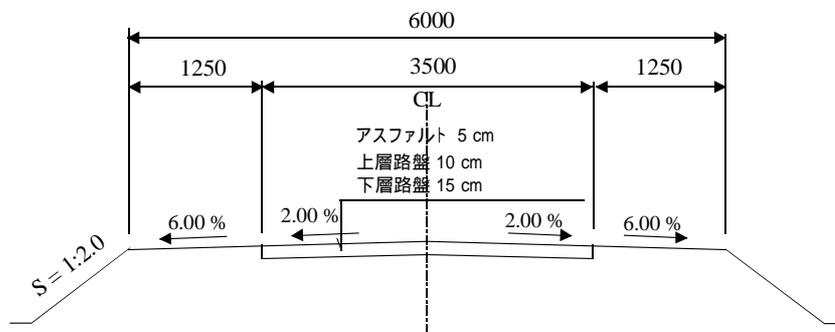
県道のアスファルト舗装（冠水しない区間）
